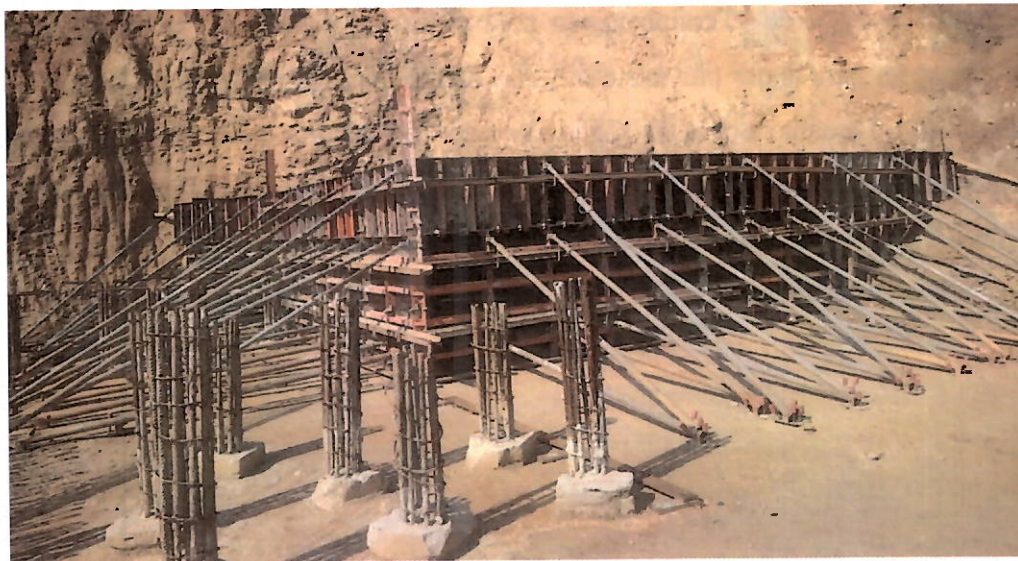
Novo Marapicu: obra de terraplanagem e construção do muro de contraforte.
